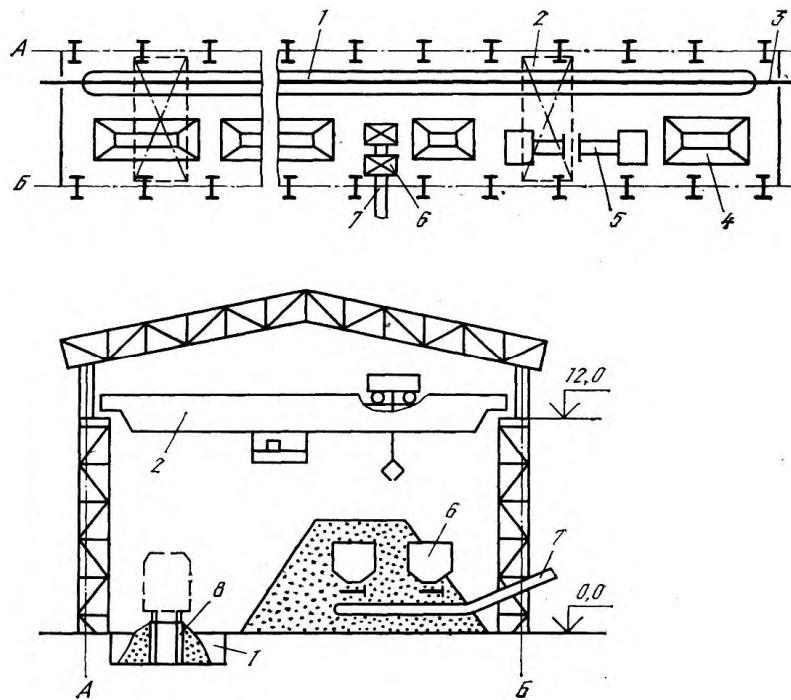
План и поперечный разрез нижнего шихтового отделения с хранением материалов в штабелях
